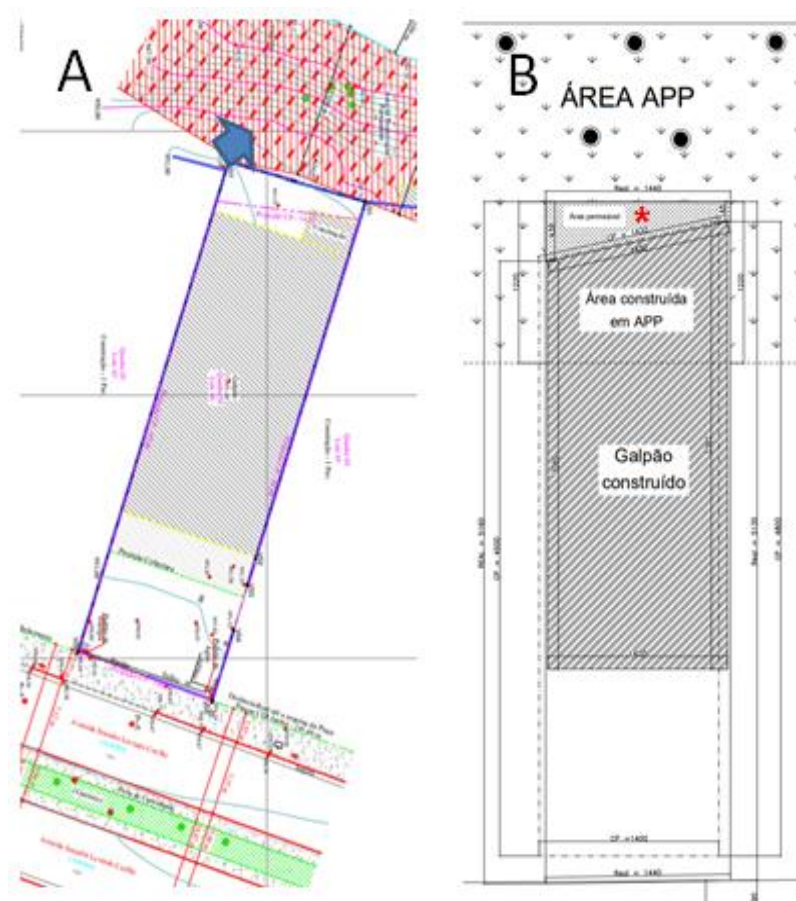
Levantamento Planialtimétrico. Em A - Delimitação de APP de 15 metros (seta azul) e em B – Planta de ocupação e área permeável (*) (Fonte: Adaptado do Protocolo 06460/22).
